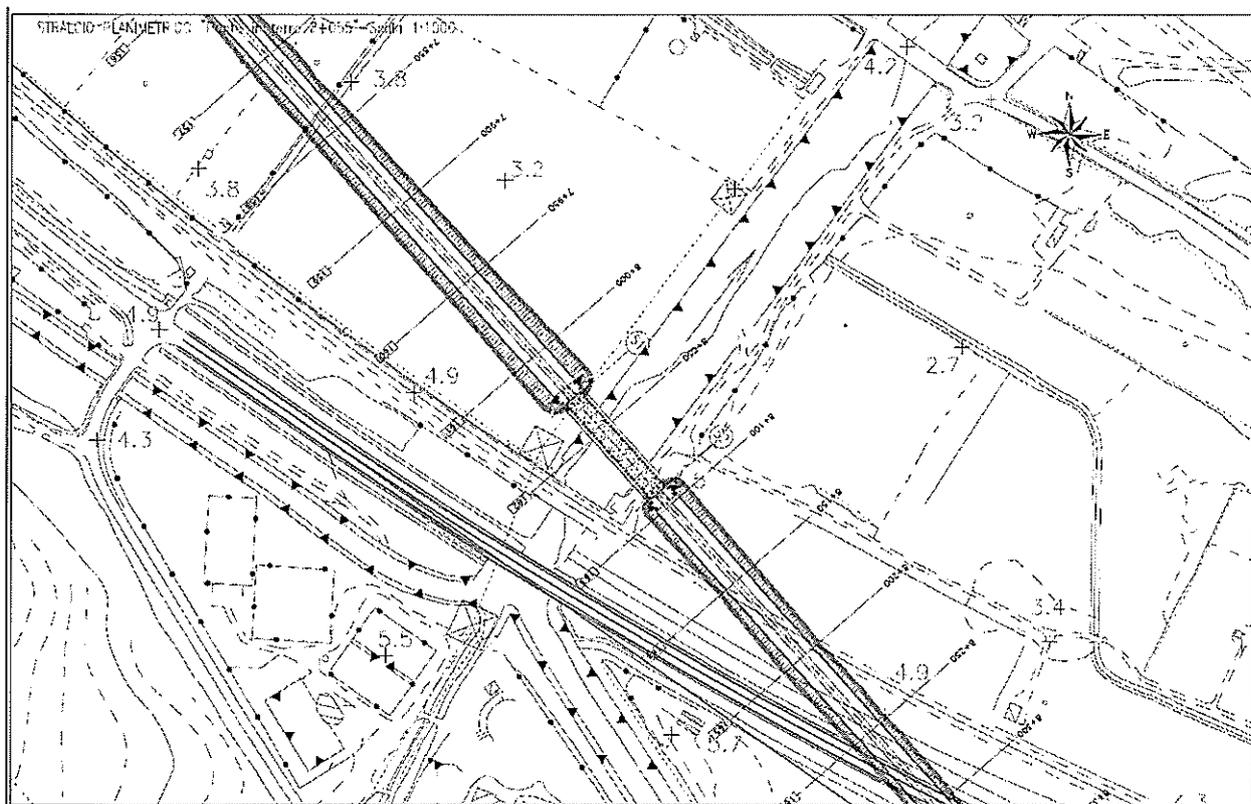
Travata metallica sul collettore "Bonifica di Ramitelli": stralcio planimetrico
